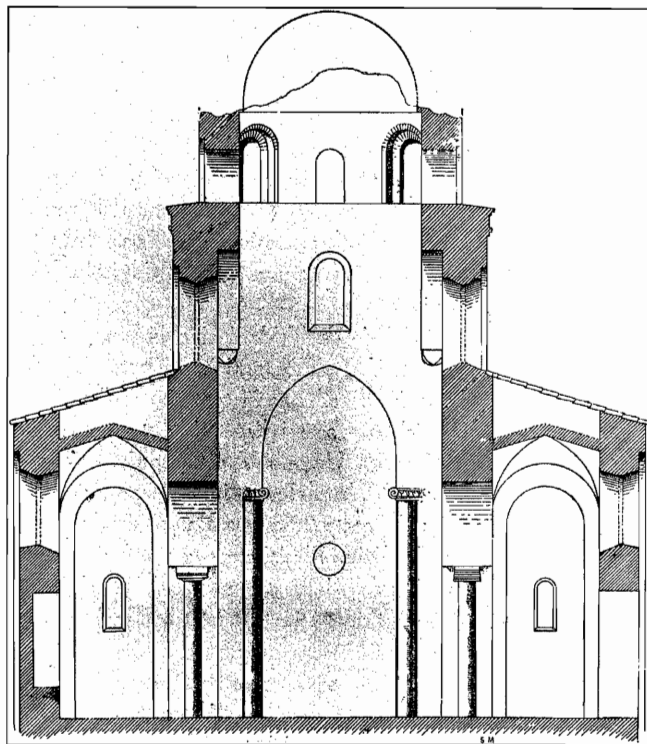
Staiti. Santa Maria de Tridetti. Presbiterio. Sezione trasversale (Orsi-Carta 1913)
